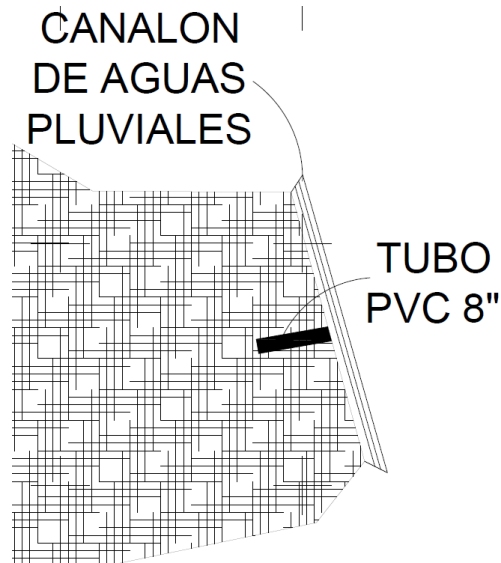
Ilustración No. II.10 Sección longitudinal del muro de contención del proyecto.
